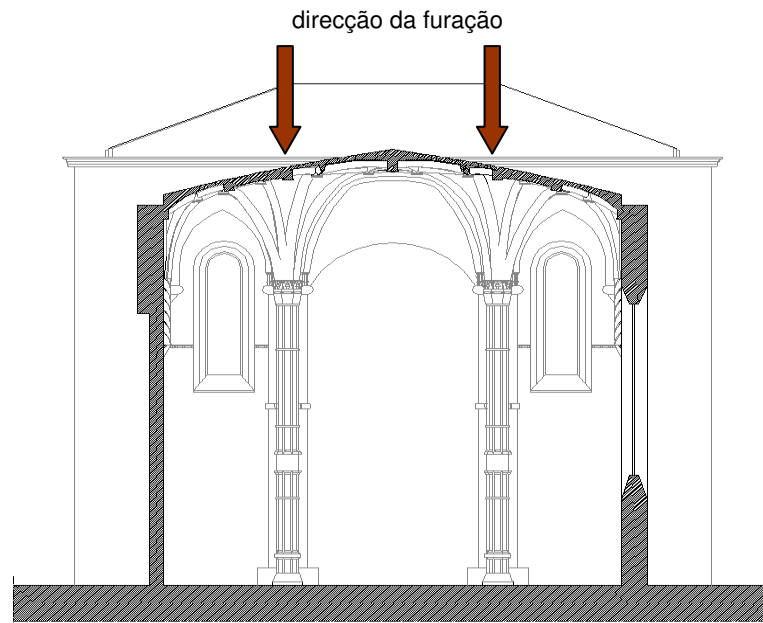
Furação dos pilares da nave, a partir do extradorso da abóbada, para introdução da armadura de reforço.
